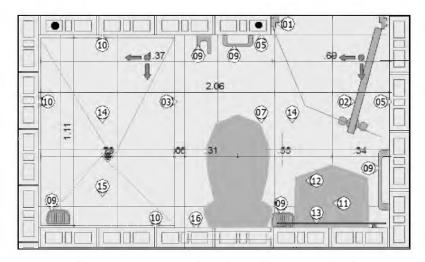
Futura adecuación con la distribución de la mampostería y sus respectivas dovelas (arriba), Plano donde se ilustra el espacio como se entrega el apartamento
